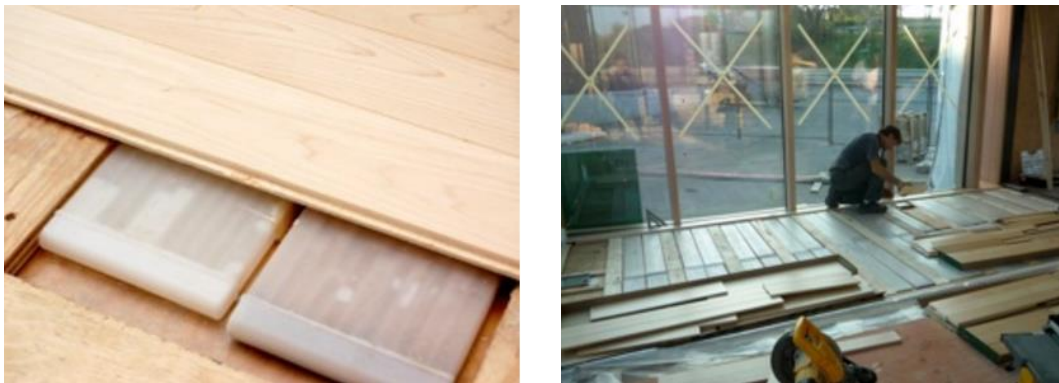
Instalación de DELTA-COOL 21 para el pavimento de la North House. Fuente: [38]
